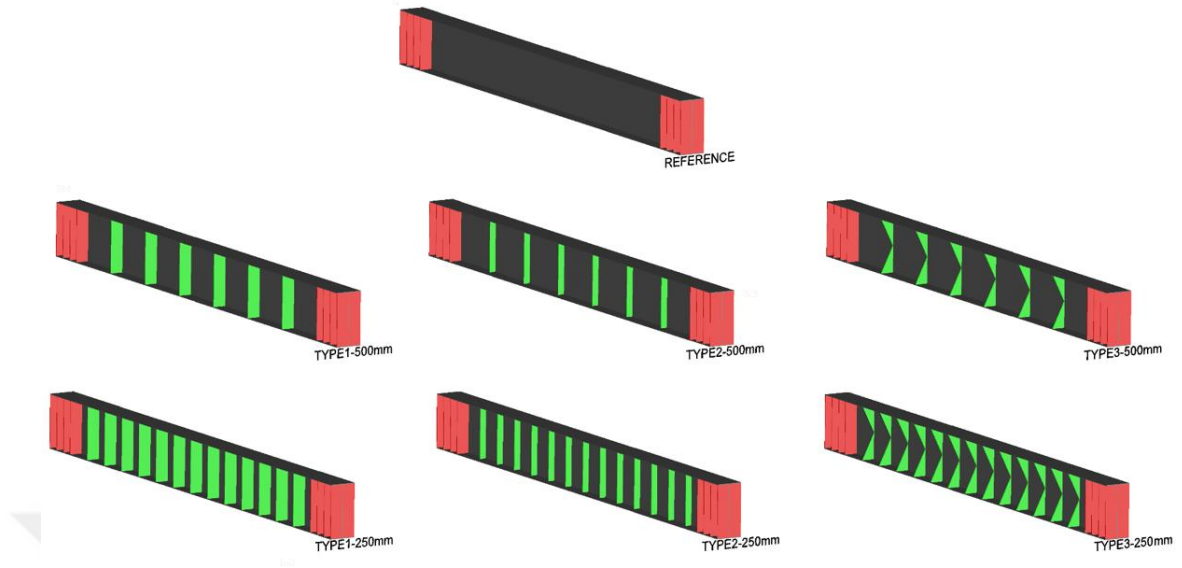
250mm berkitme aralıklı kirişlerin kesit görünüşleri
